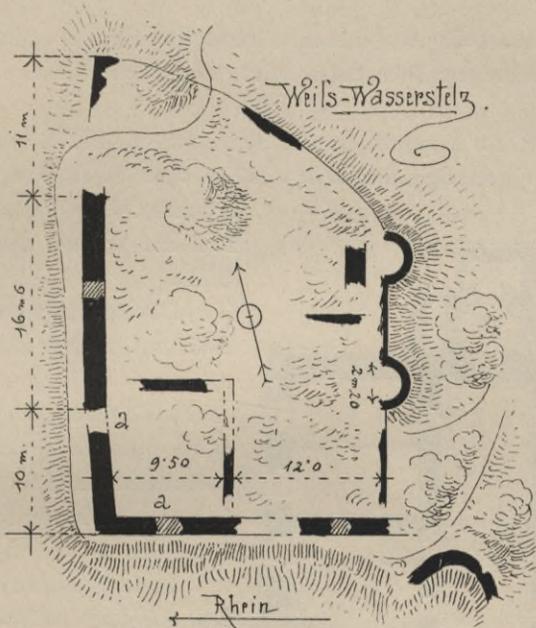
Weisswasserstelz. Grundriss der Burg. II.
